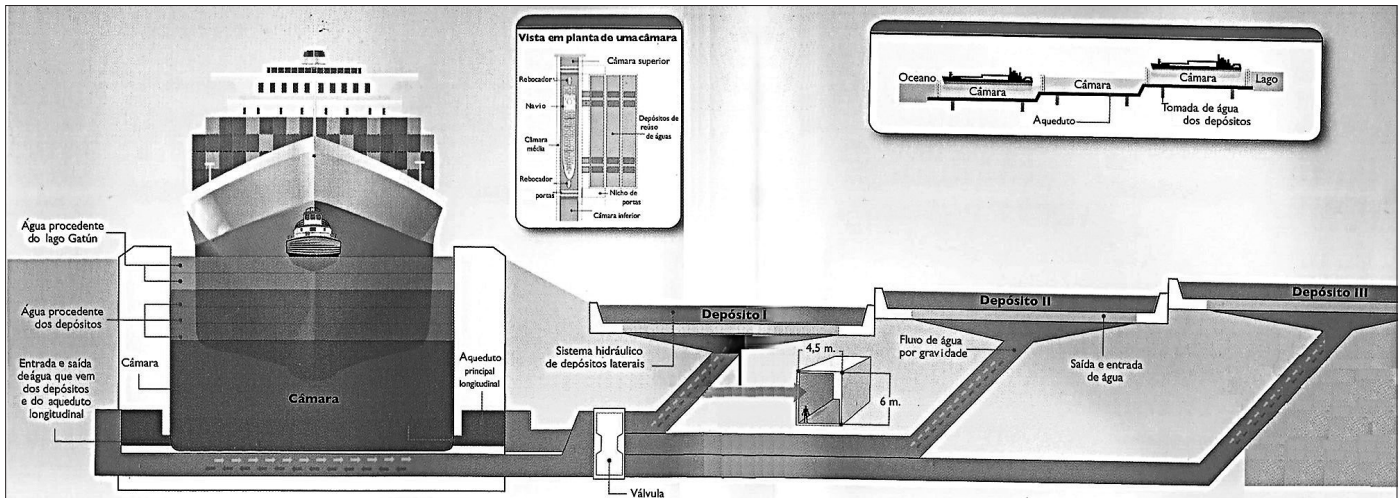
Esquematisações em elevação da seção transversal e da seção longitudinal e em planta do sistema de reuso de água no terceiro jogo de eclusas.
